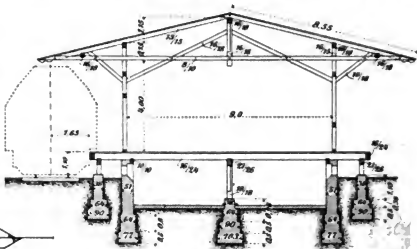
Querschnitt eines Güterschuppens für mittlere Stationen. M. 1 : 200.
